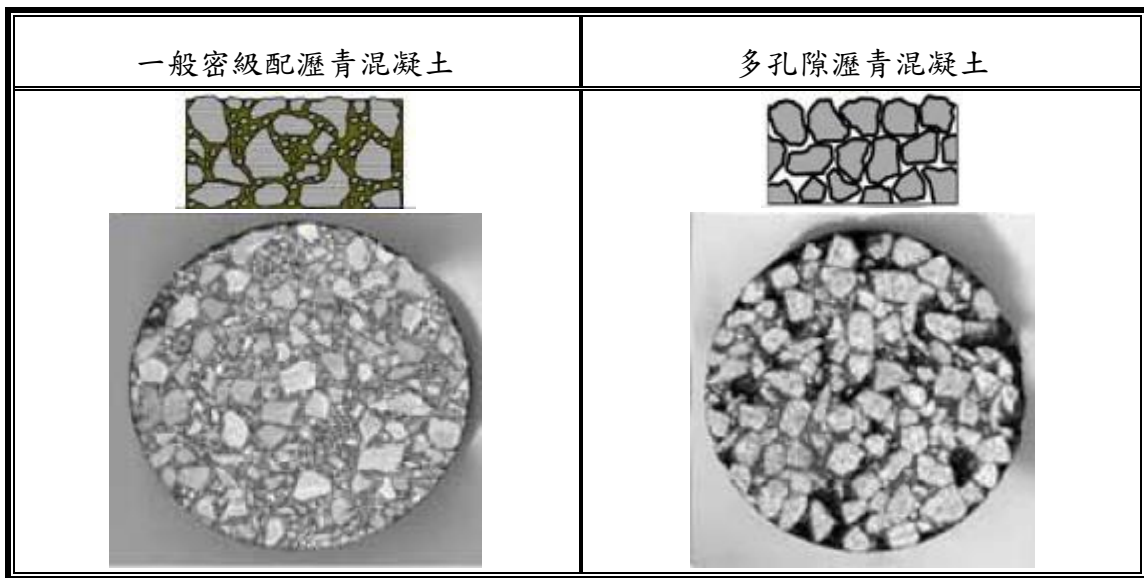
一般密級配瀝青混凝土與多孔隙瀝青混凝土試體圖
